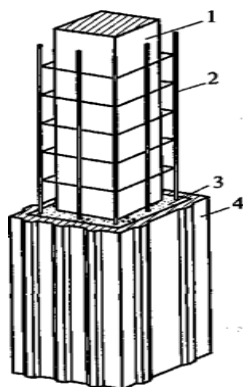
Усиление сваи с использованием железобетонной обоймы: 1- ствол усиливаемой сваи; 2- арматурный каркас (стальная обойма); 3- бетон омоноличивания; 4- облицовка
